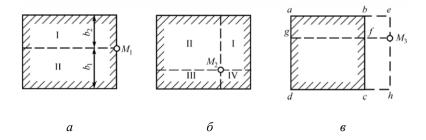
Схемы построения прямоугольников загрузки при определении осадок по методу угловых точек
